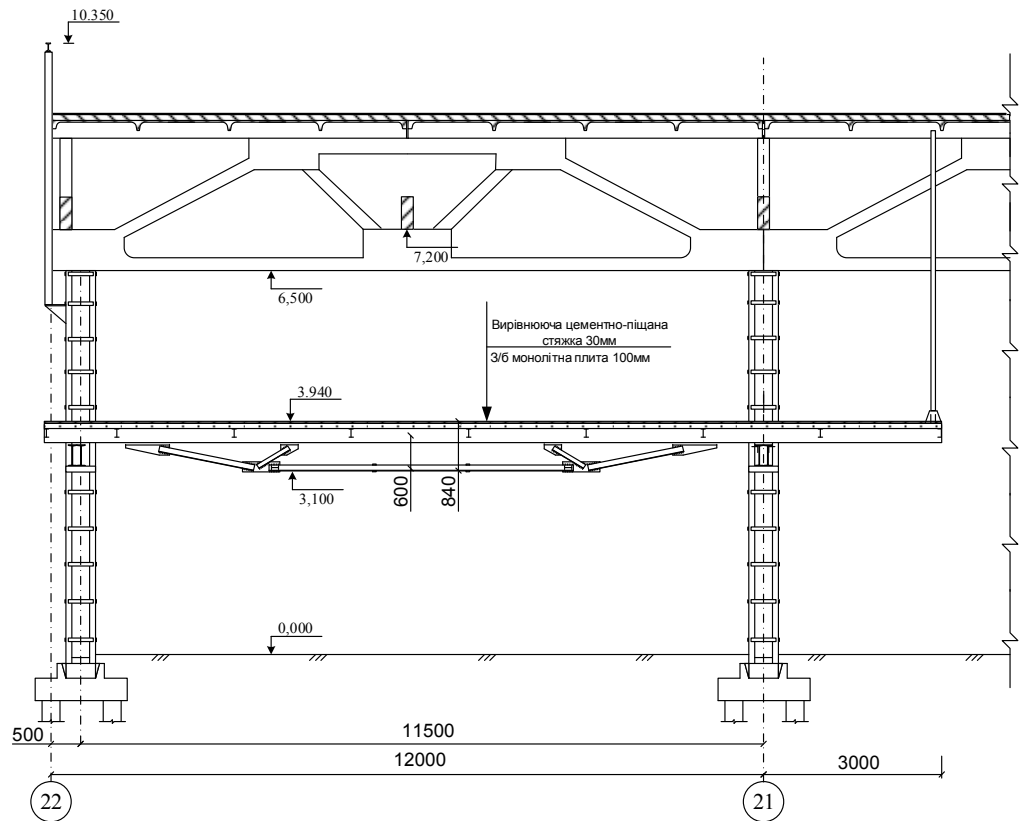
Головна несуча конструкція сталезалізобетонного перекриття, прольотом 11,5 м
